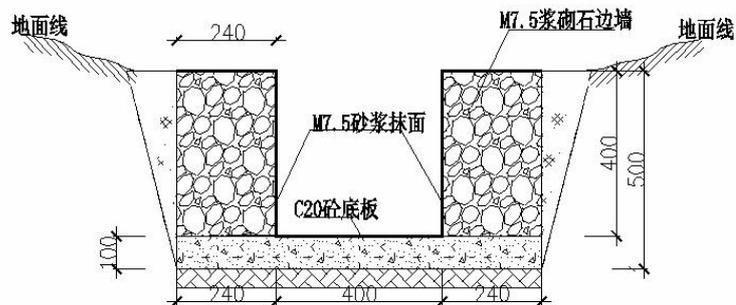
截排水沟（0.4*0.4m）截面设计示意图（单位： m）
